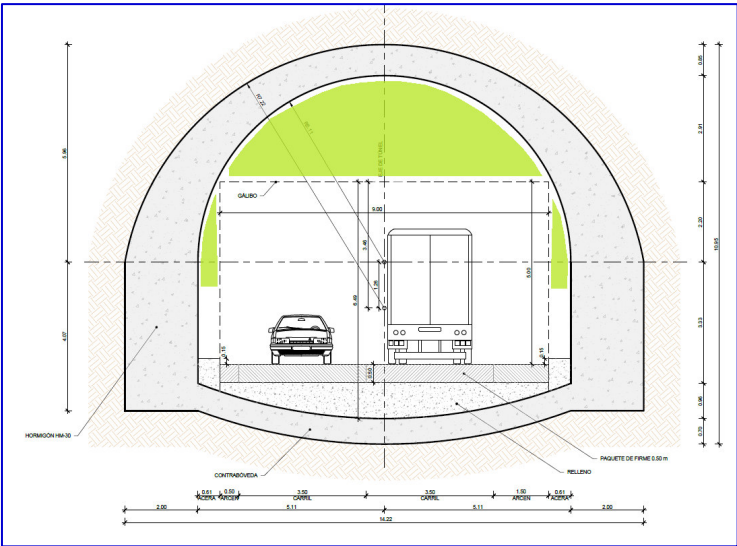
Sección útil del túnel en mina, con zonas en verde disponibles para la instalación de equipos
